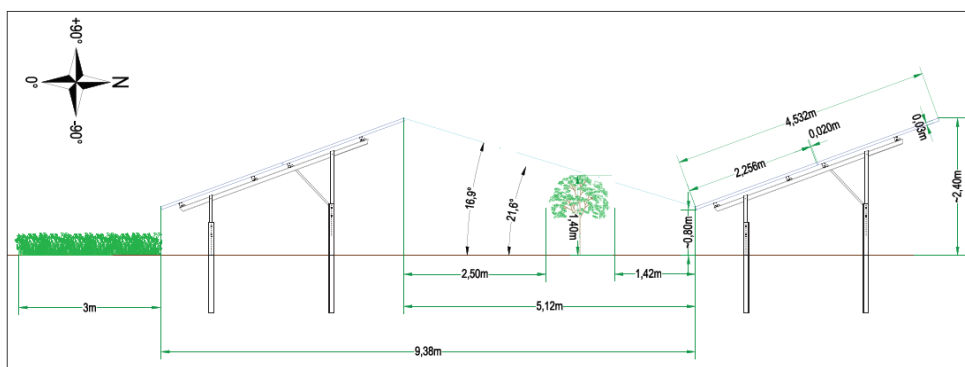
schéma de disposition des chênes truffiers par rapport aux panneaux solaires
